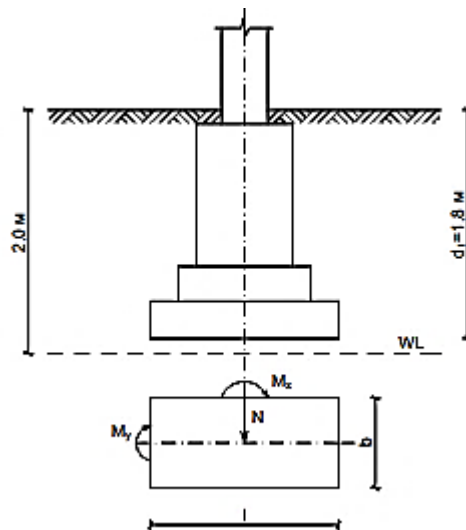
Схема розташування фундаменту у ґрунті і навантажень на фундамент
